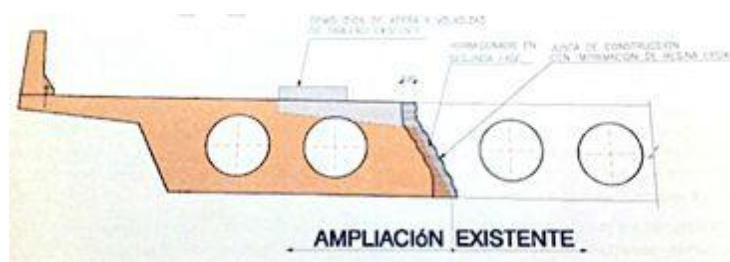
Detalle Ampliación del tablero de un puente de Hormigón in-situ
